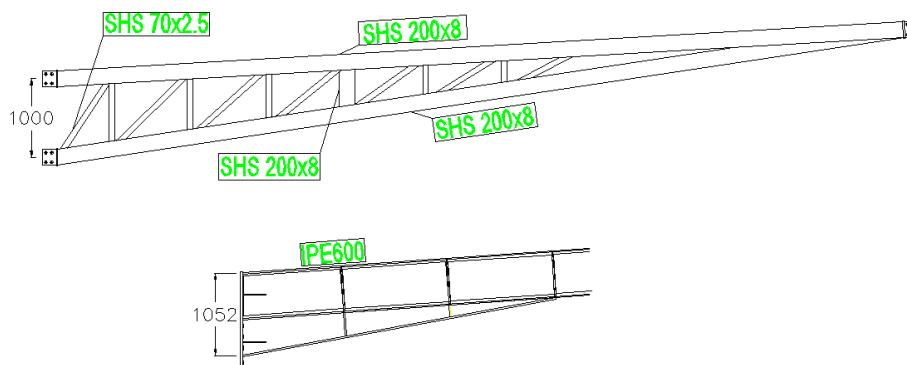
Comparação entre peça da viga adotada (em cima) e pormenor da zona correspondente da estrutura da solução base (em baixo)
